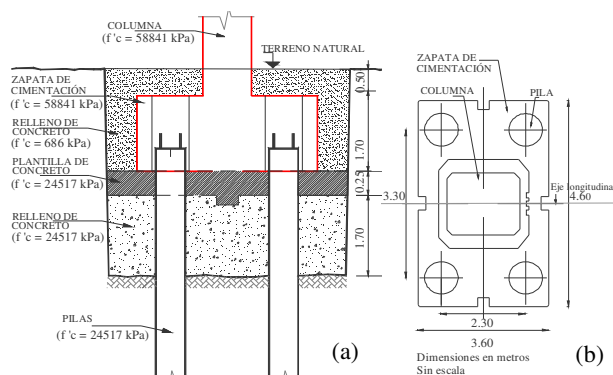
Esquema de la cimentación (a) elevación (b) planta.
